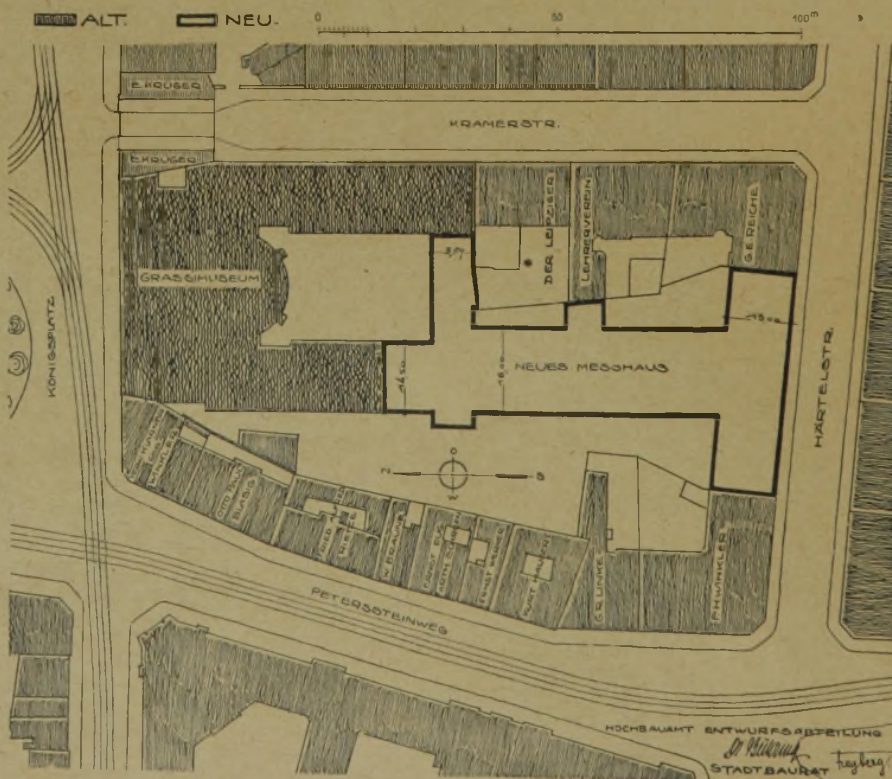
Lageplan des Grassi-Textil-Meßhauses in Leipzig.
